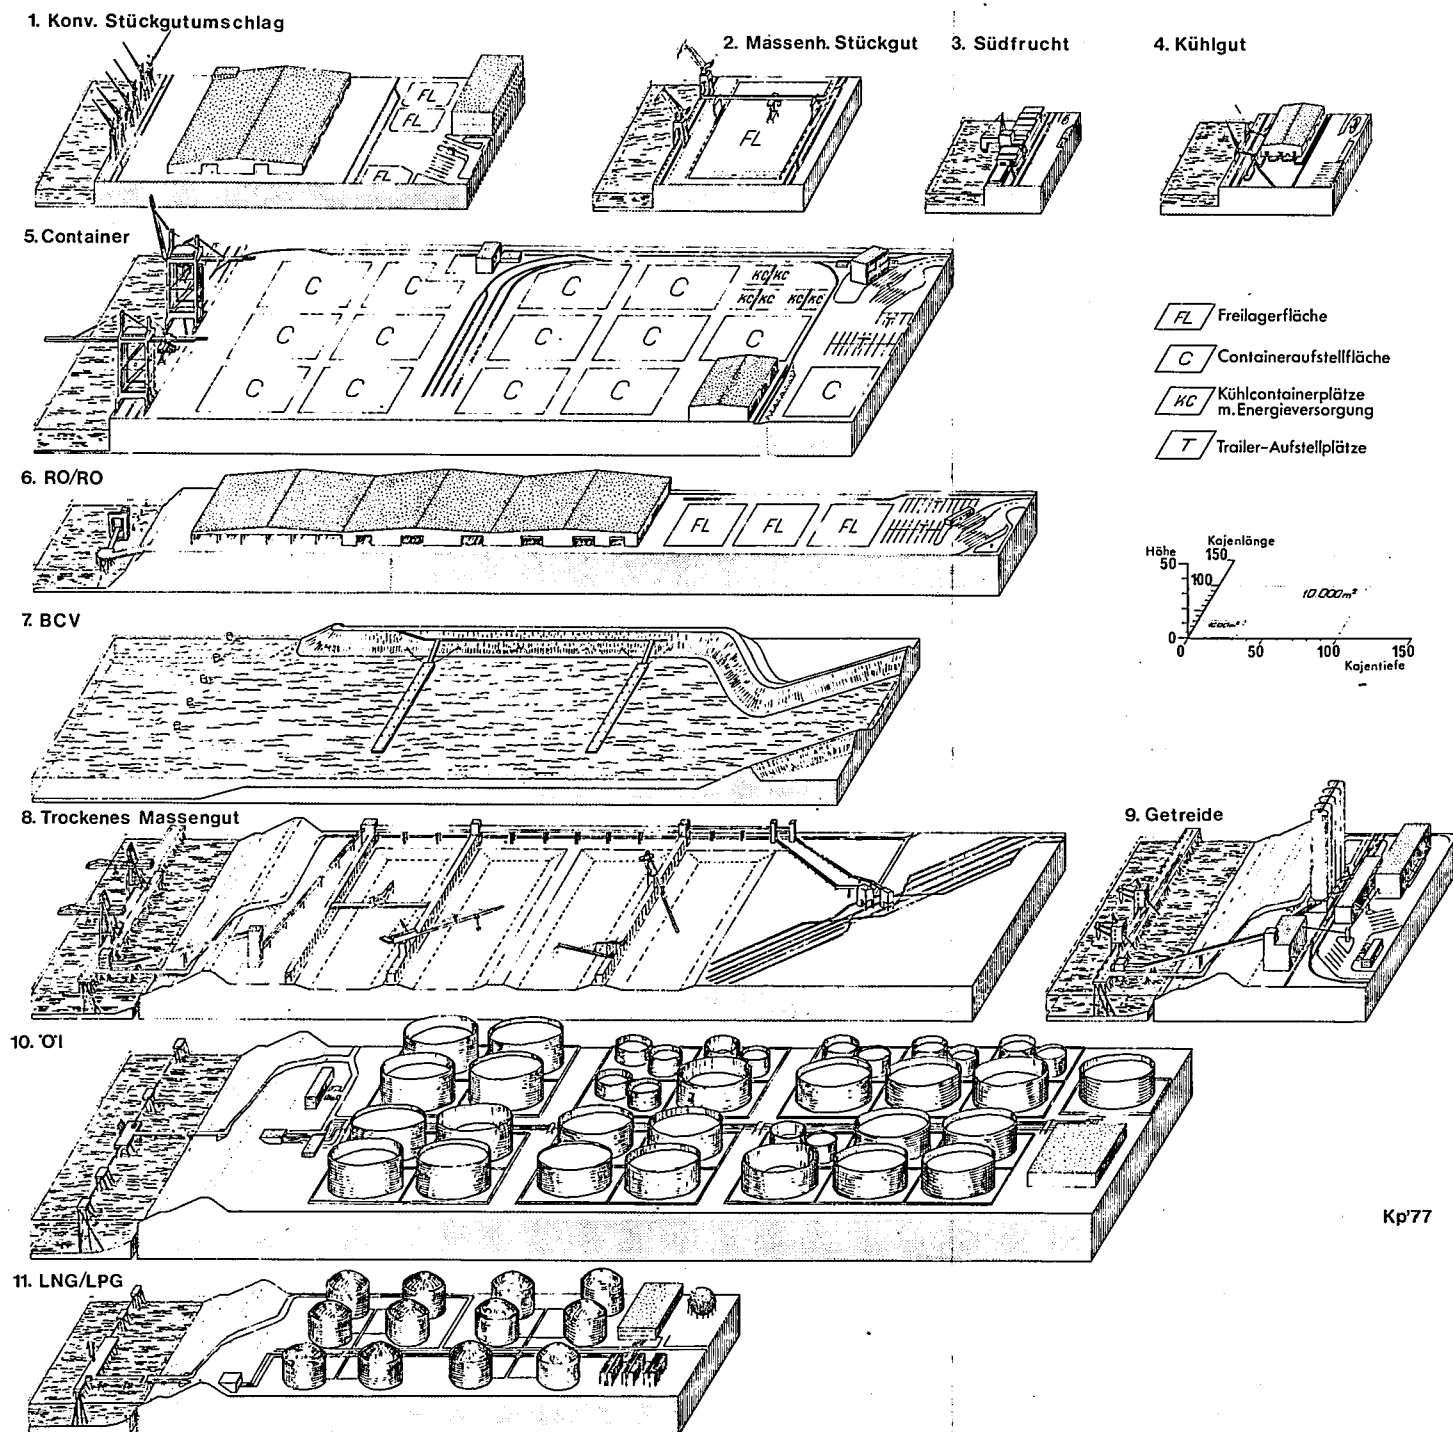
Spezialhäfen, Grundriß und Ausstattung (Schemata)
